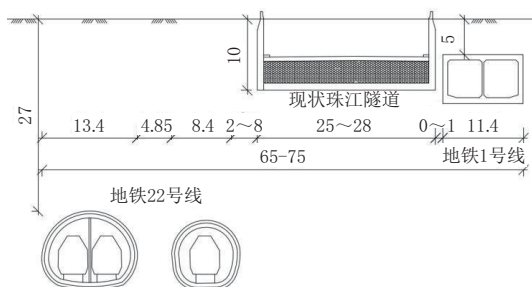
地铁线路与珠江隧道位置关系剖面图(单位:m)
